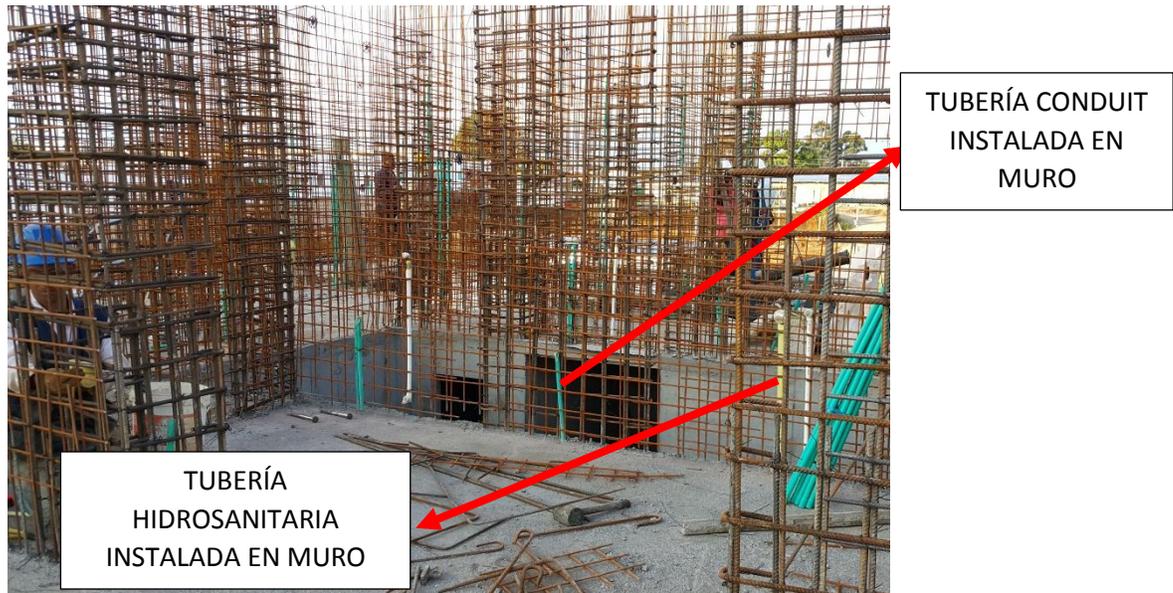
Instalación de tubería Conduit e Hidrosanitaria en muro para su posterior conexión.
